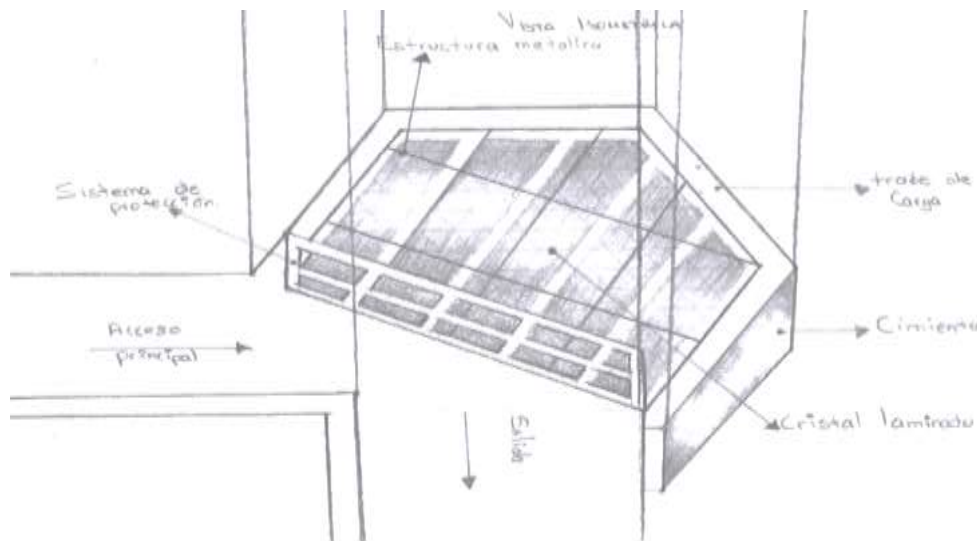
Boceto con adaptación de cristal a la estructura del Torreón Sur-Oriente en la Ex Hacienda de Xico para propuesta de mirador.
